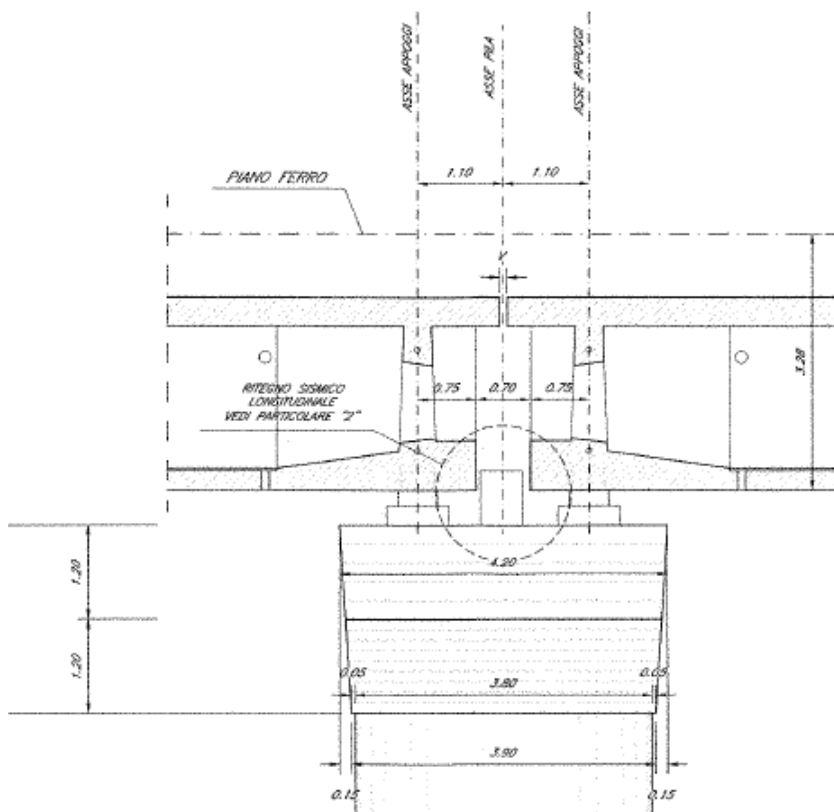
Pila, prospetto longitudinale – Due impalcati CAP
